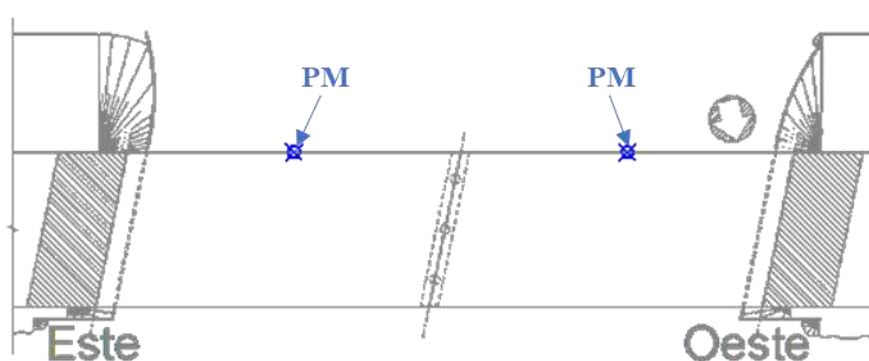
Posición de los acelerómetros en la planta del puente calle Paso.
